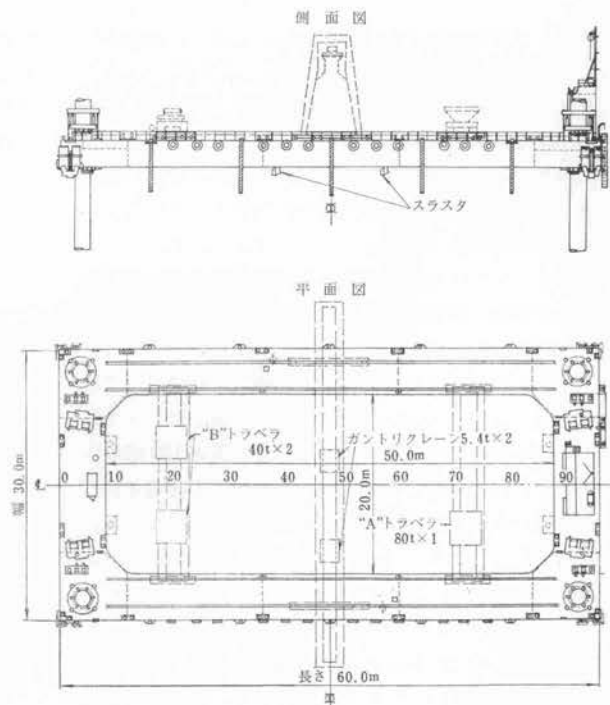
自揚式作業台 MSEP-1 "せと" 一般配置図
